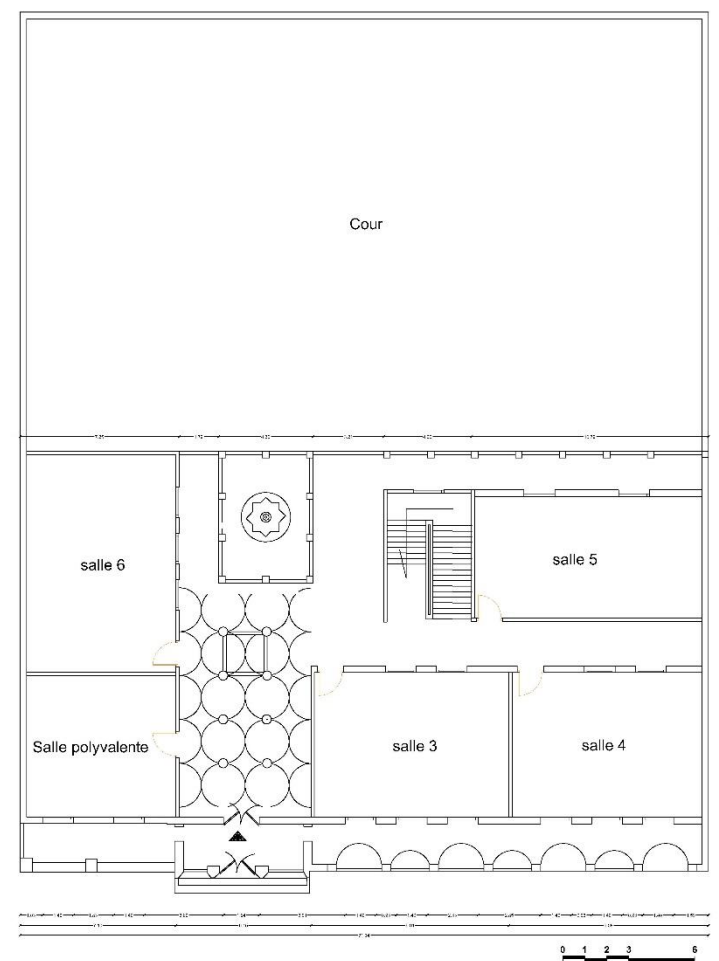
Plan 1ère Etage Groupe scolaire catégorie –B-
